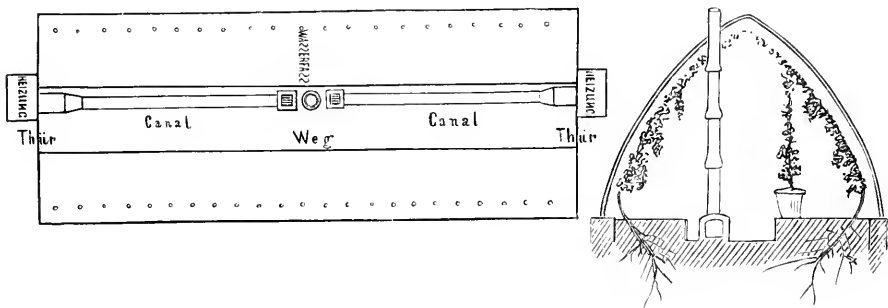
Grundriss und Querschnitt des Lerot'schen Weinhauses in Vilvorde, Belgien.
